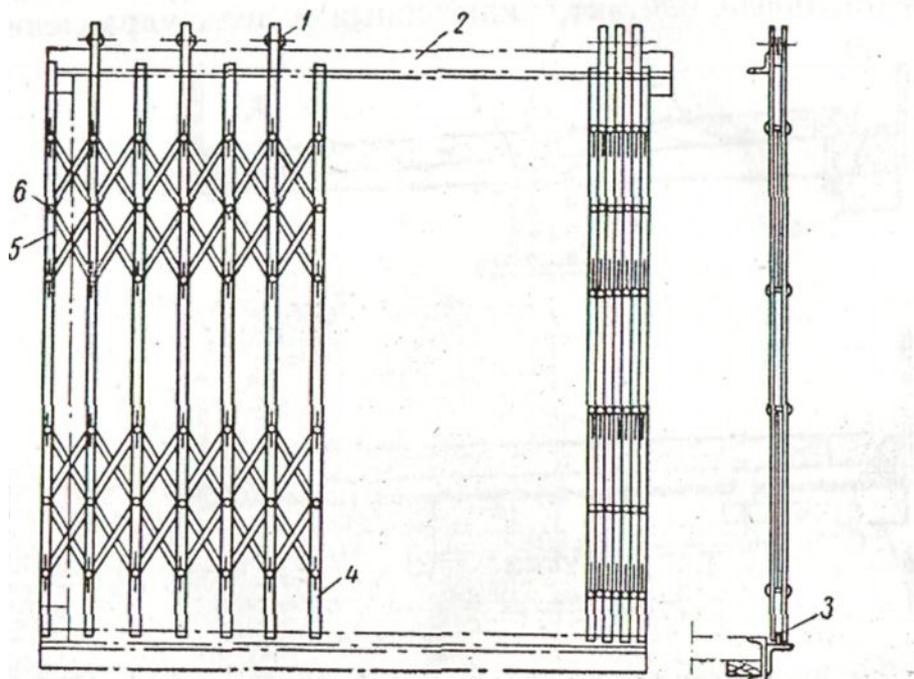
Решетчатая раздвижная дверь кабины грузового лифта
